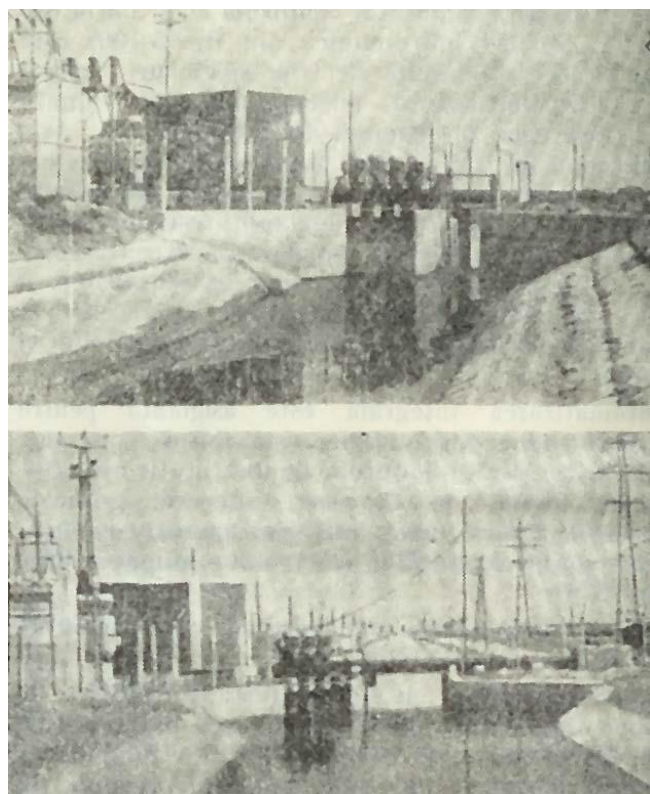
(foto). Stații de punere sub presiune, pe canalele de distribuție: a – Stp cu cădere în stație și stăvilă; b – Stp fără cădere în stație și fără stăvilă
